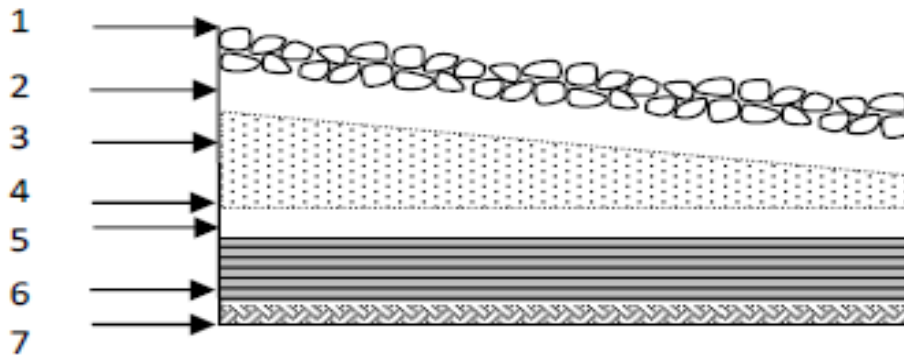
Coupe verticale du dernier plancher (terrasse inaccessible).
